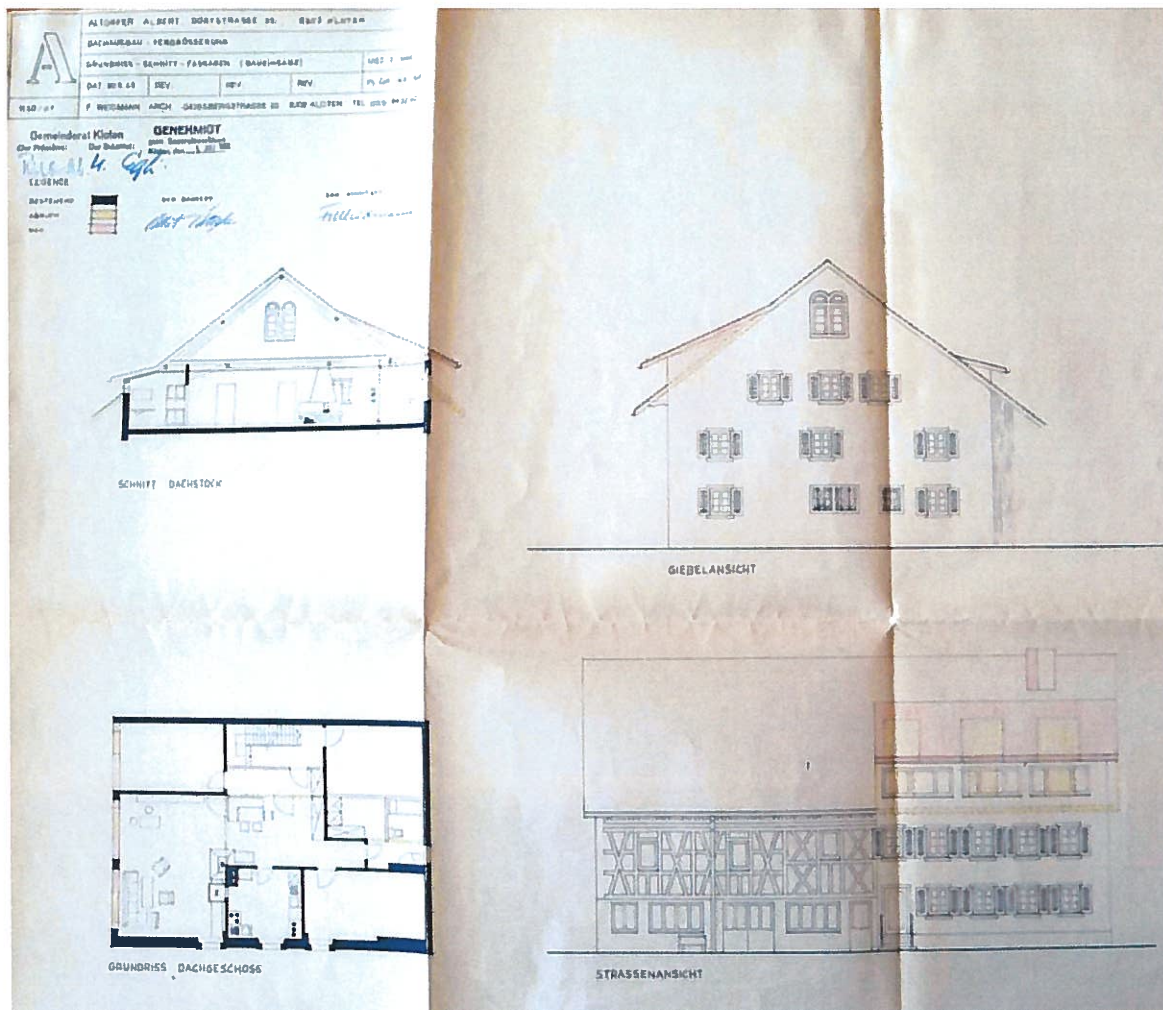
Vergrößerung der Dachwohnung und Einbau einer grossen Schleppdachlukarne. Grundriss, Südfassade, Ostfassade, Schnitt Dachstock, 30.5.1969. Bauakten Gemeinde Kloten.
